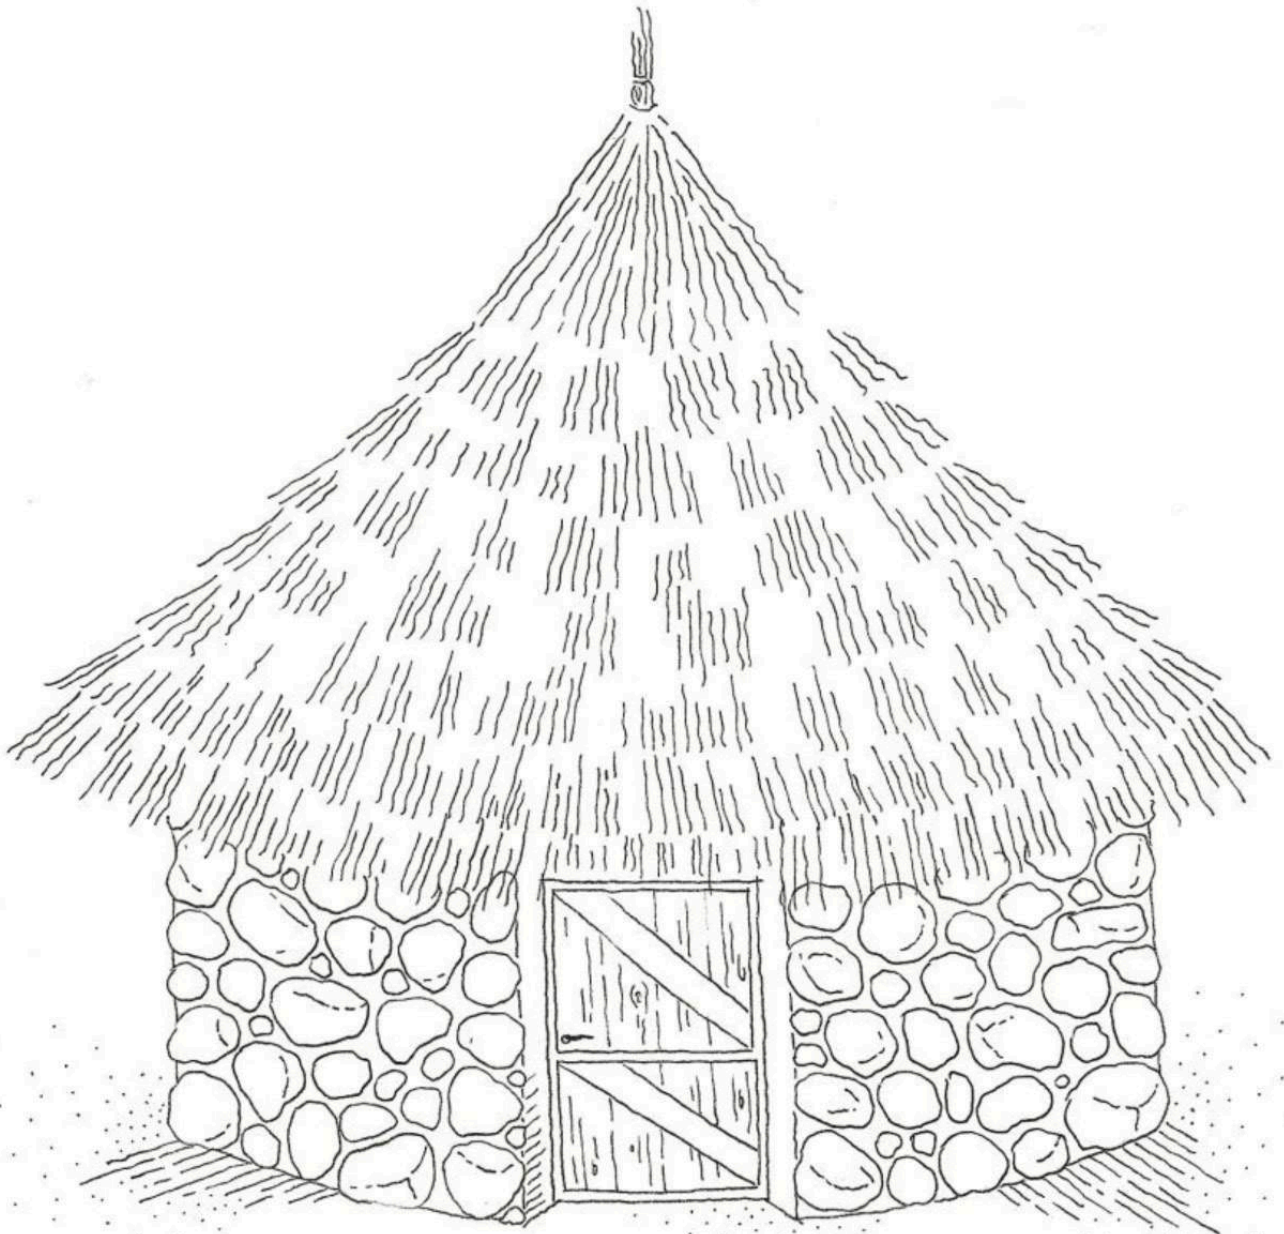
Dibujo de construcción circular ejecutada con muro de piedra
